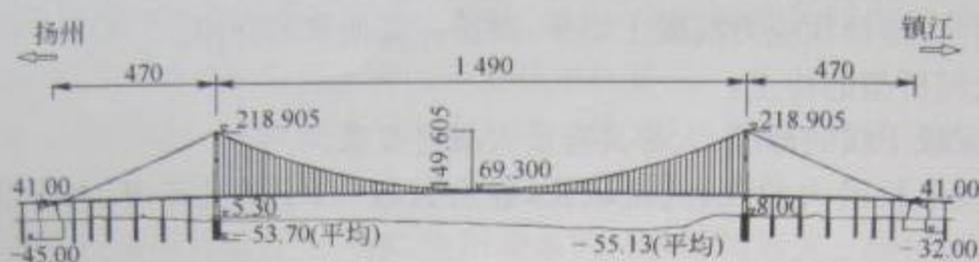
润扬长江公路大桥南汊桥(尺寸单位:m)
